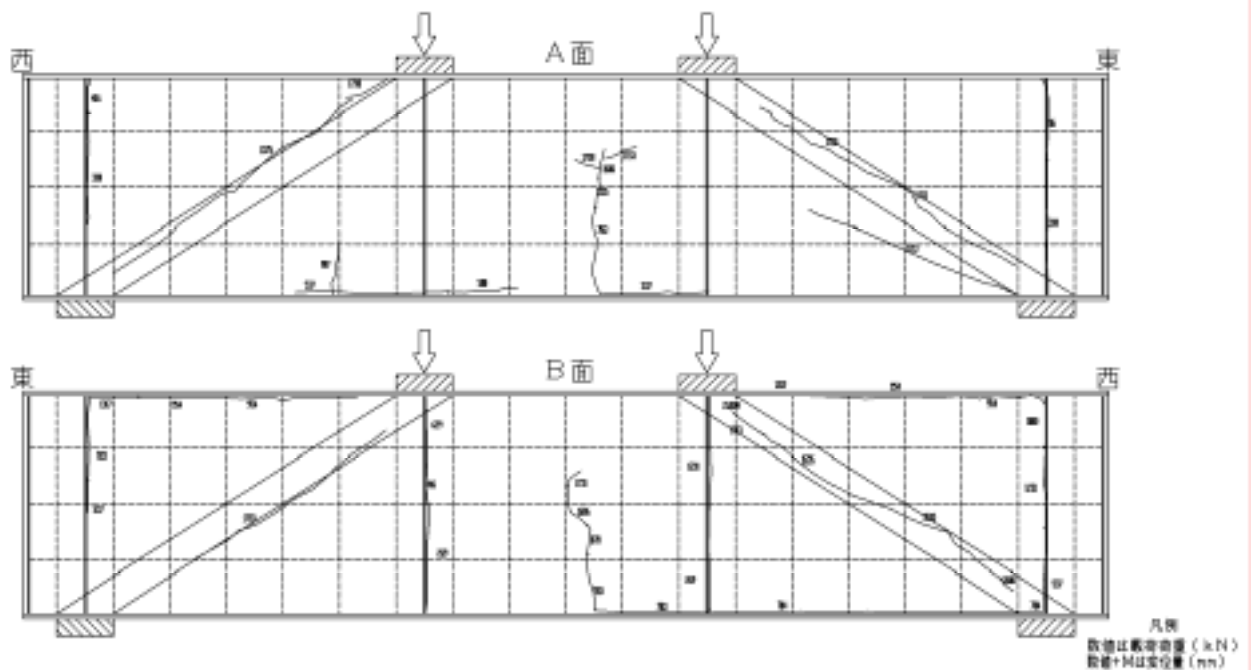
最大荷重時のひび割れ発生状況 (B-3 試験体)
